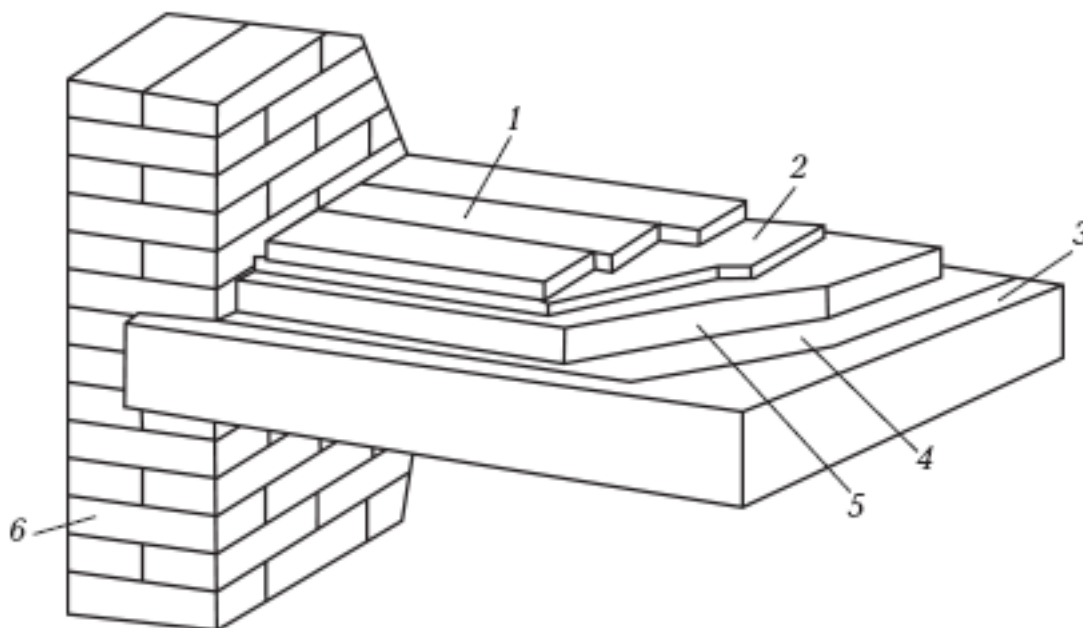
Схема утепления перекрытия по железобетонным плитам: 1 – чистовой пол; 2 – выравнивающая стяжка; 3 – железобетонное перекрытие; 4 – пароизоляция; 5 – утеплитель; 6 – несущая стена
